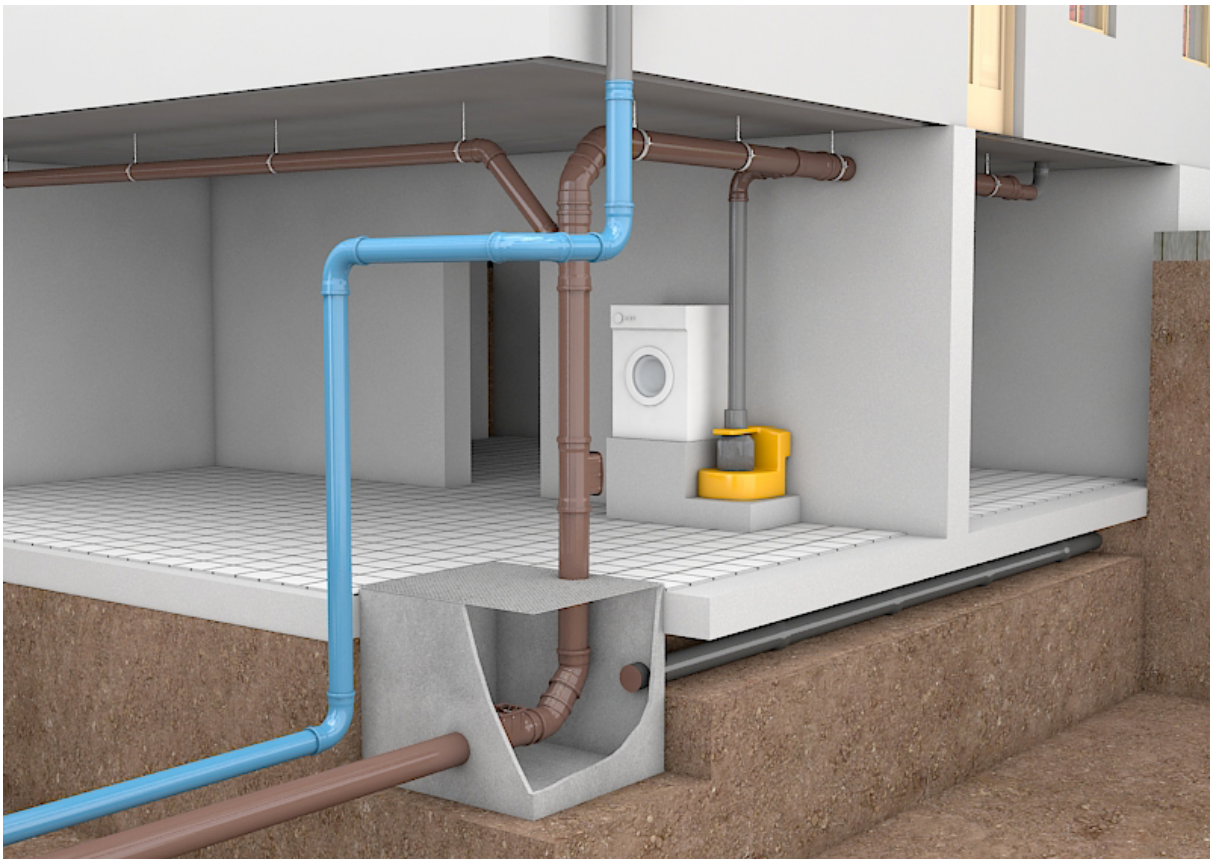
Erneuerung durch Installation von Rohren an Decken und Wänden, Beispielgrafik
